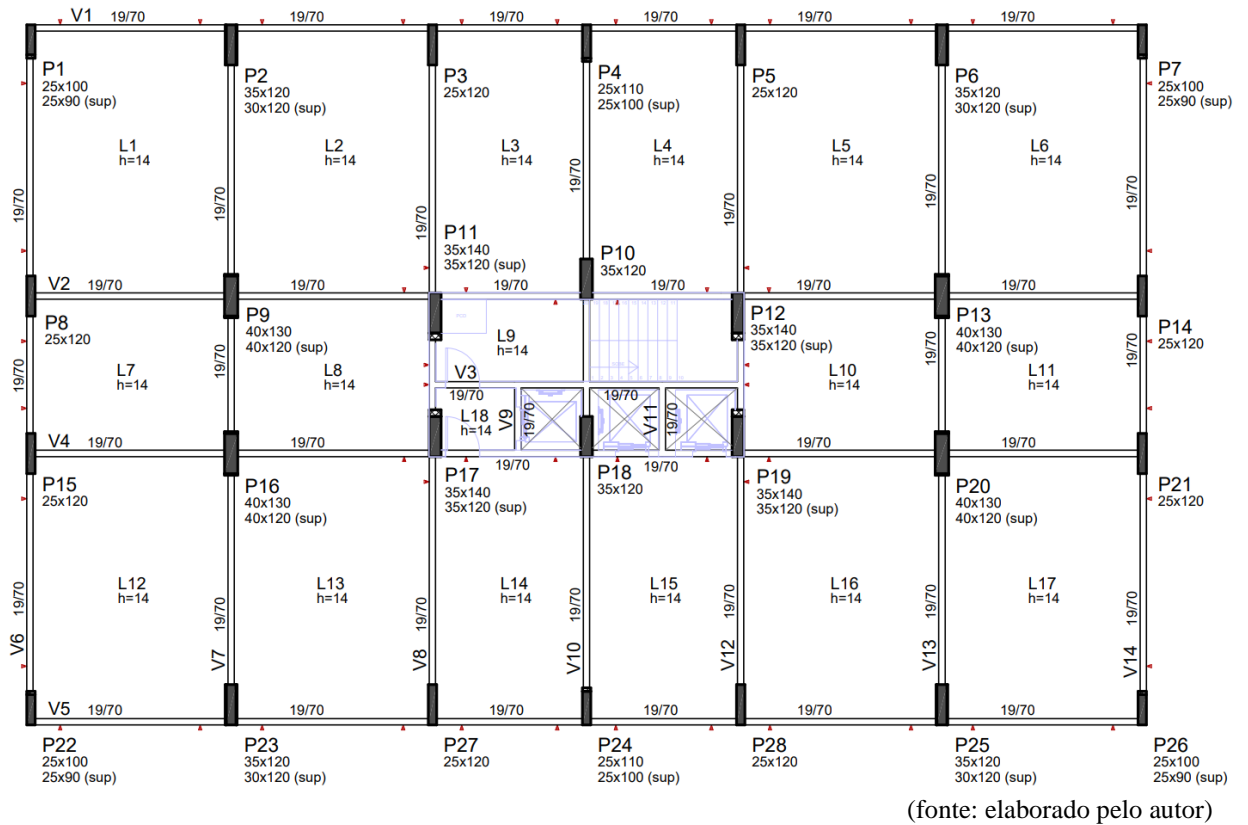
planta de fôrmas do 3º e 4º pavimentos - Tipo 3
